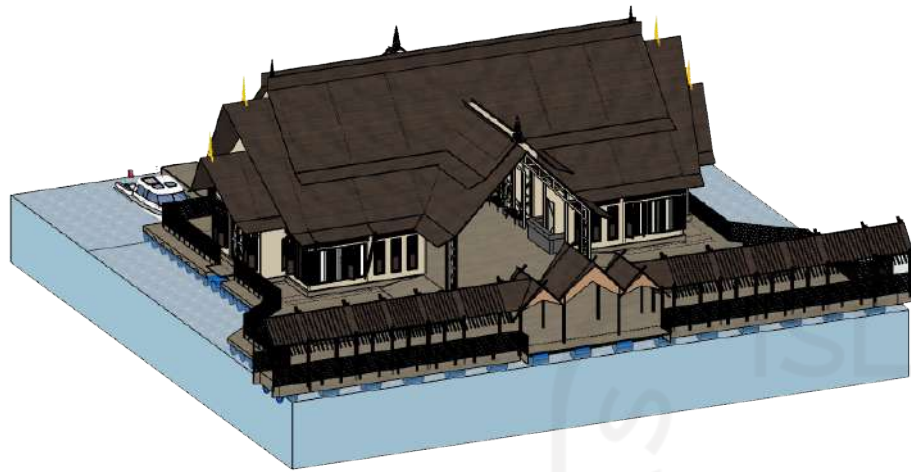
Tampak Utara Bangunan Bengkel dan Kios
